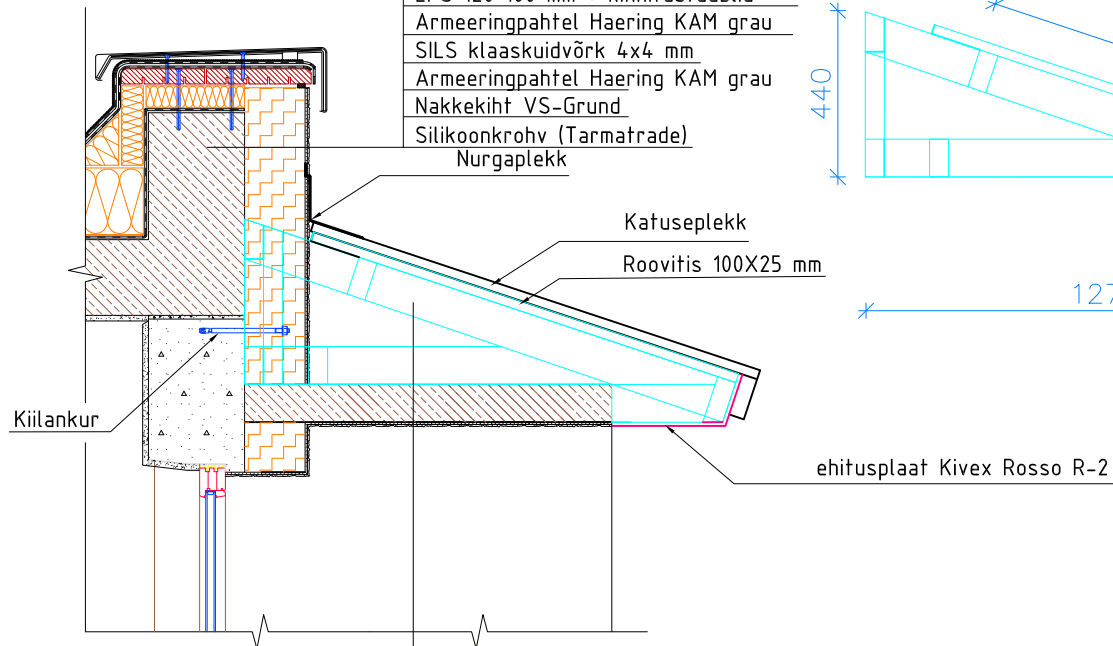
VARIKATUSE PRUSSKONSTRUKTSIOON (kogus 4 tk.)
